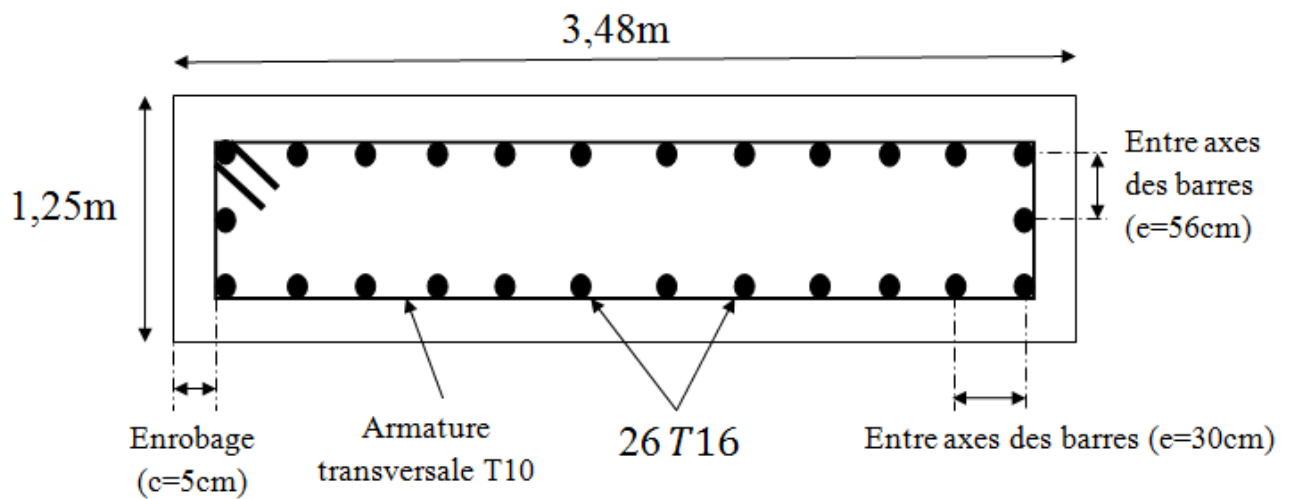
Détail de ferrailage de la poutre de couronnement.
